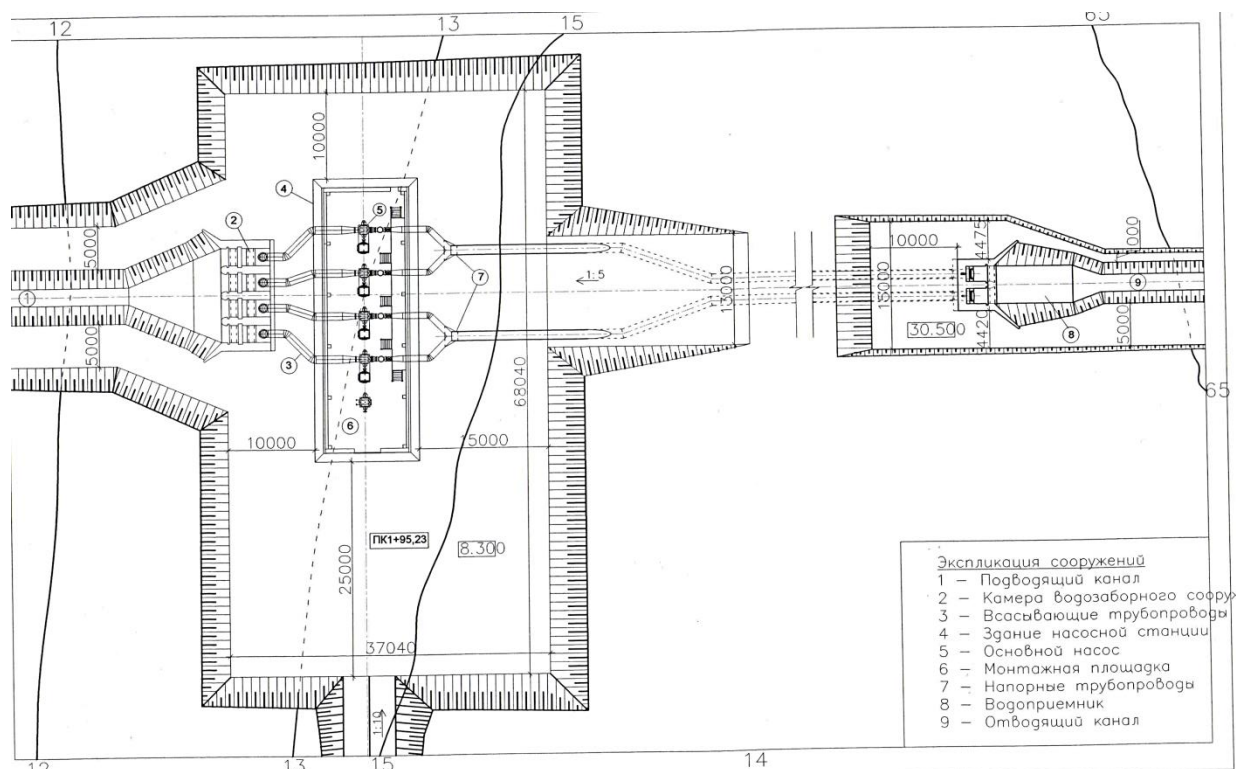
Генплан водозаборного гидроузла с насосной станцией
